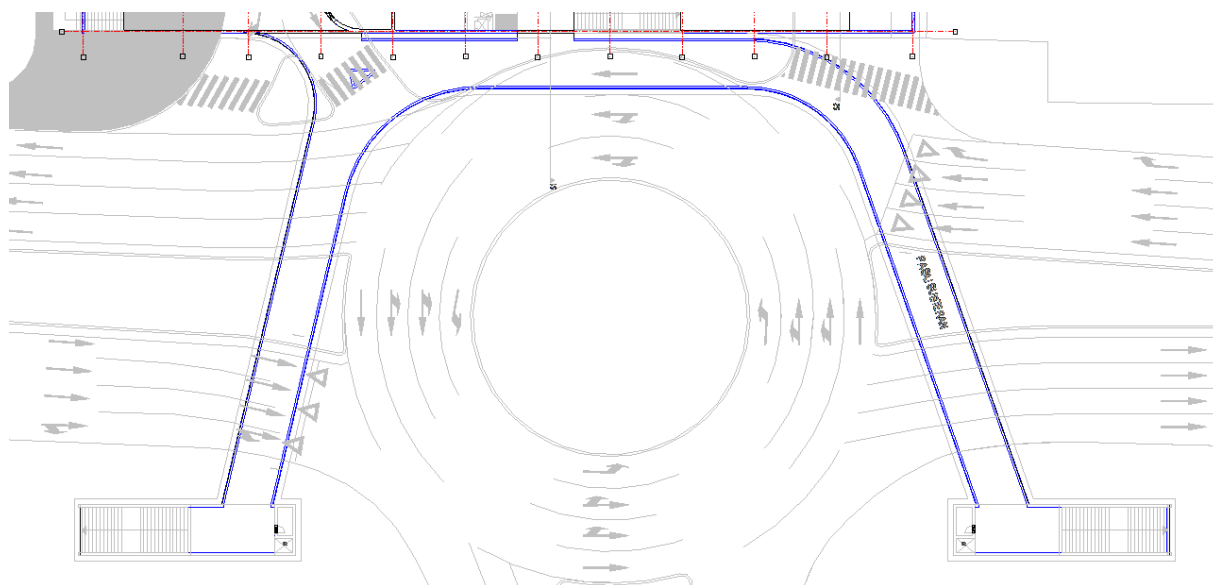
Suprapunere în plan a pasajului subteran și Bd. Gării
